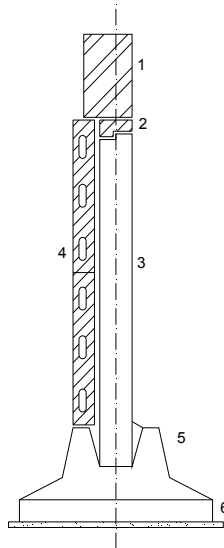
Схема столбчатого фундамента под стены здания:
